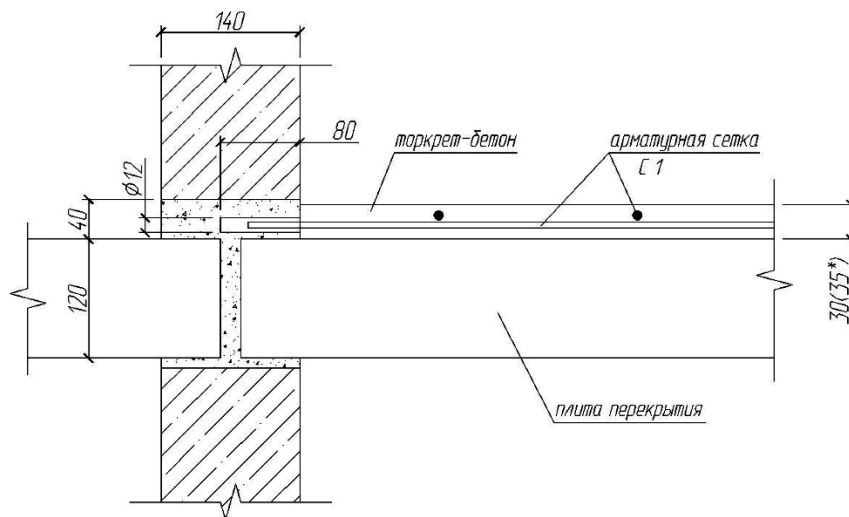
Схема усиления плиты перекрытия наращиванием сверху
